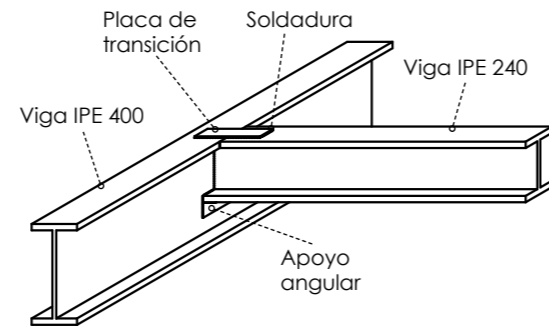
Unión viga principal con viga secundaria Elaboración propia (2026). V1-V2
